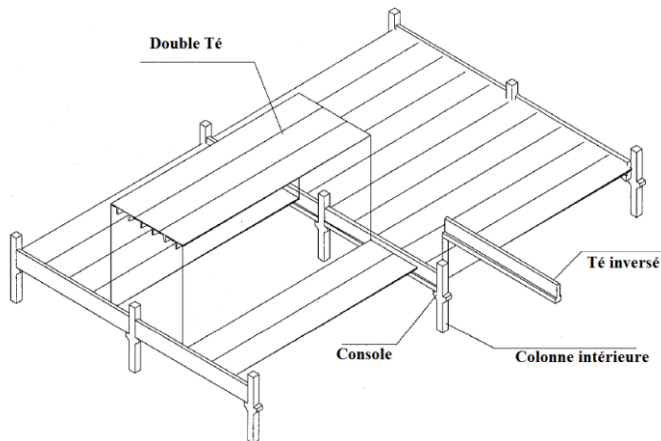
Prototype d'un garage de voiture où on voit l'utilité des consoles courtes en béton armé
